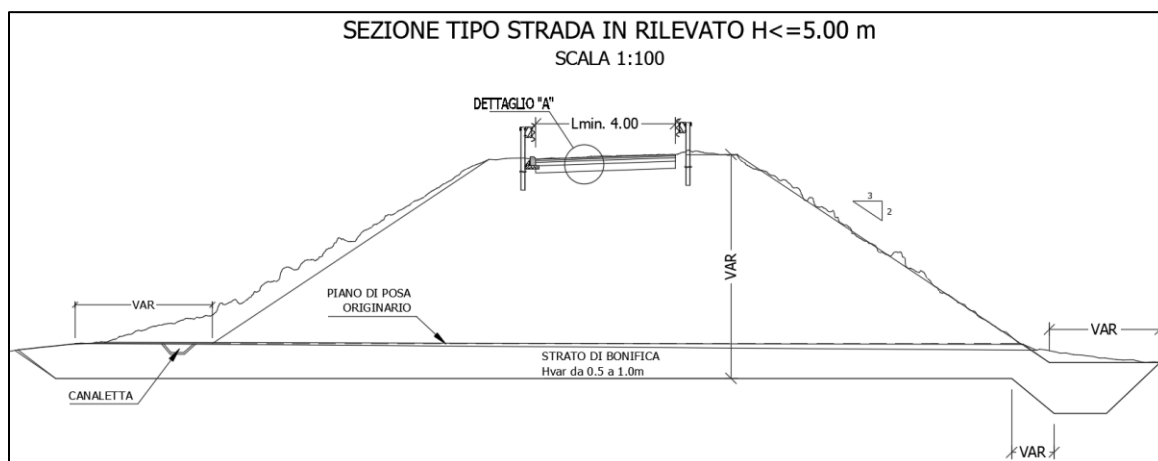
Sezione tipo strada in rilevato con  $H \leq 5$  m
